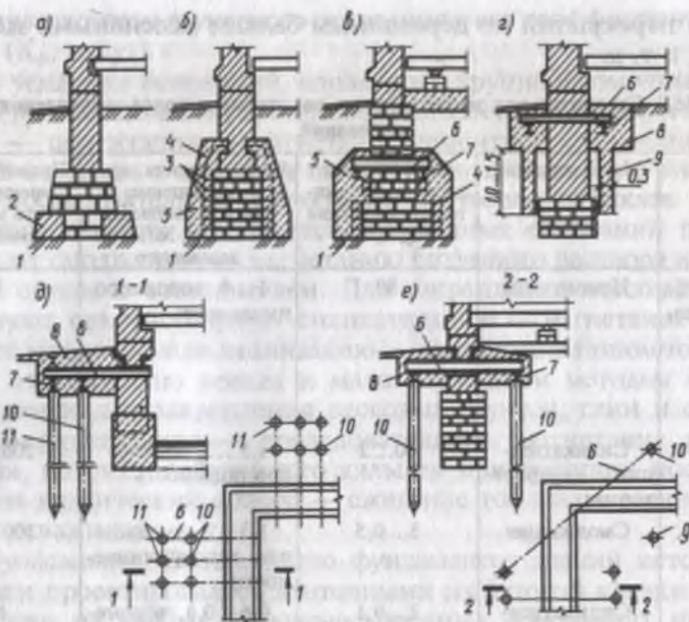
Усиление и разгрузка ленточных фундаментов:
